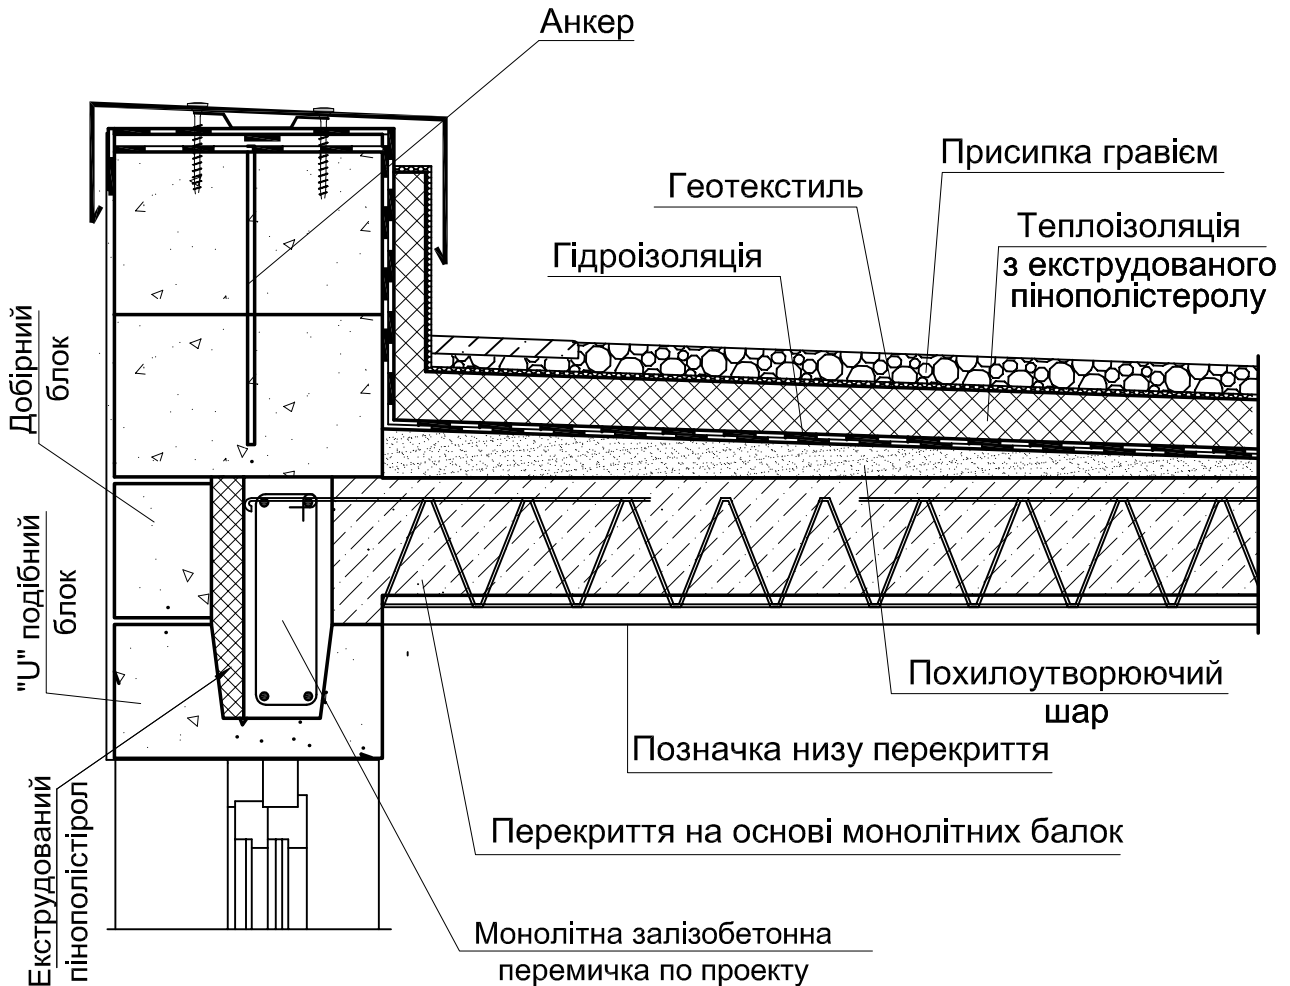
Конструювання утепленого плоского даху над збірно-монолітним дрібноштучним перекриттям. Проекція здовж несучих балок
